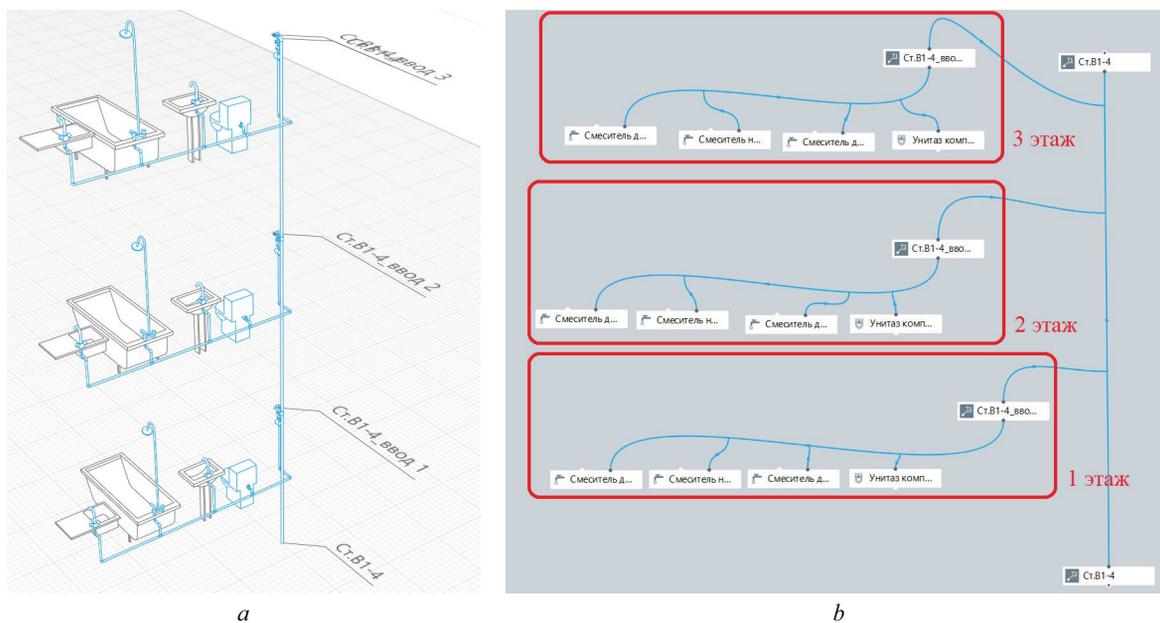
Создание типовой разводки водопровода по этажам здания: вид на 3D-сцене (а); вид во вкладке «Трубопроводные системы» (b)
